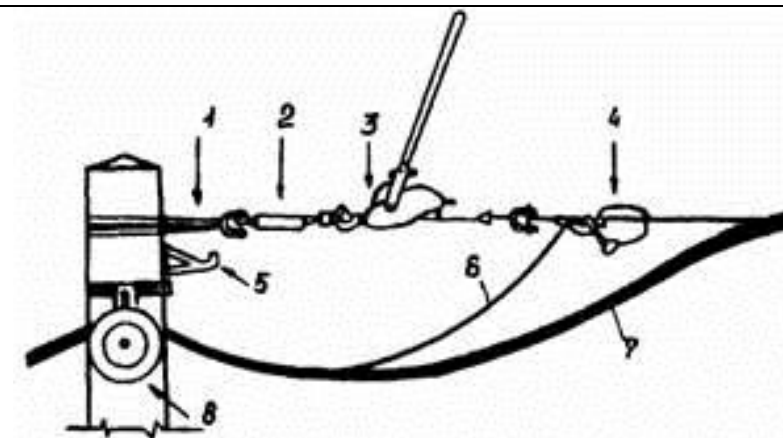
Схема натягивающего приспособления на вершине опоры
